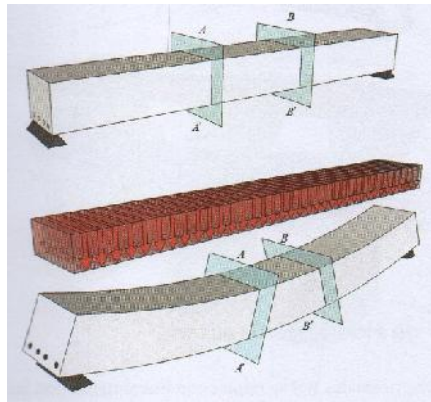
figura de viga deformada fuente (Lamus & Andrade, 2015)
